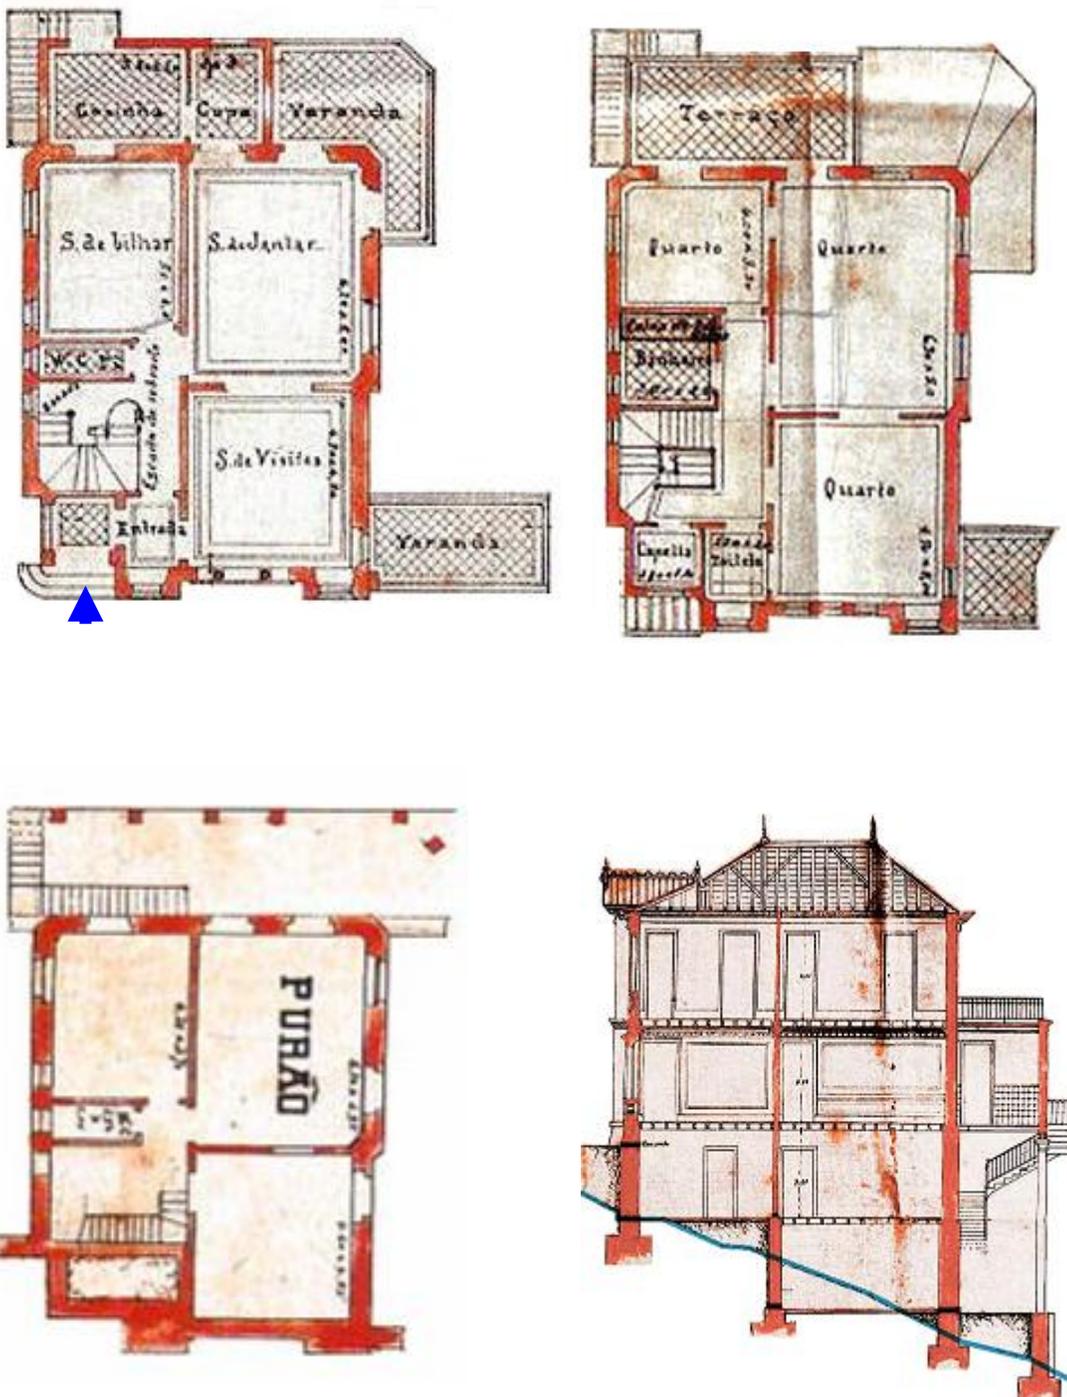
, 105, 106, 107: Acima, planta do pavimento de acesso e do pavimento superior. Abaixo, planta do porão e o corte longitudinal.
